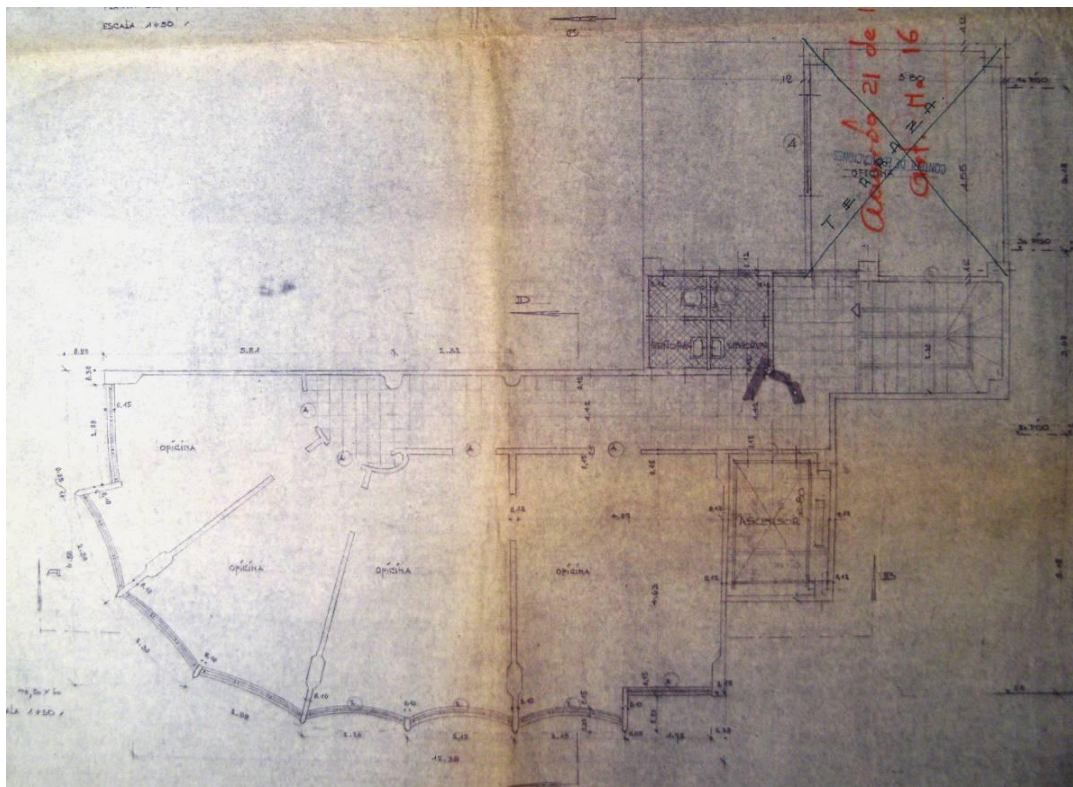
Grundriss des 4. und 5. Geschosses.
